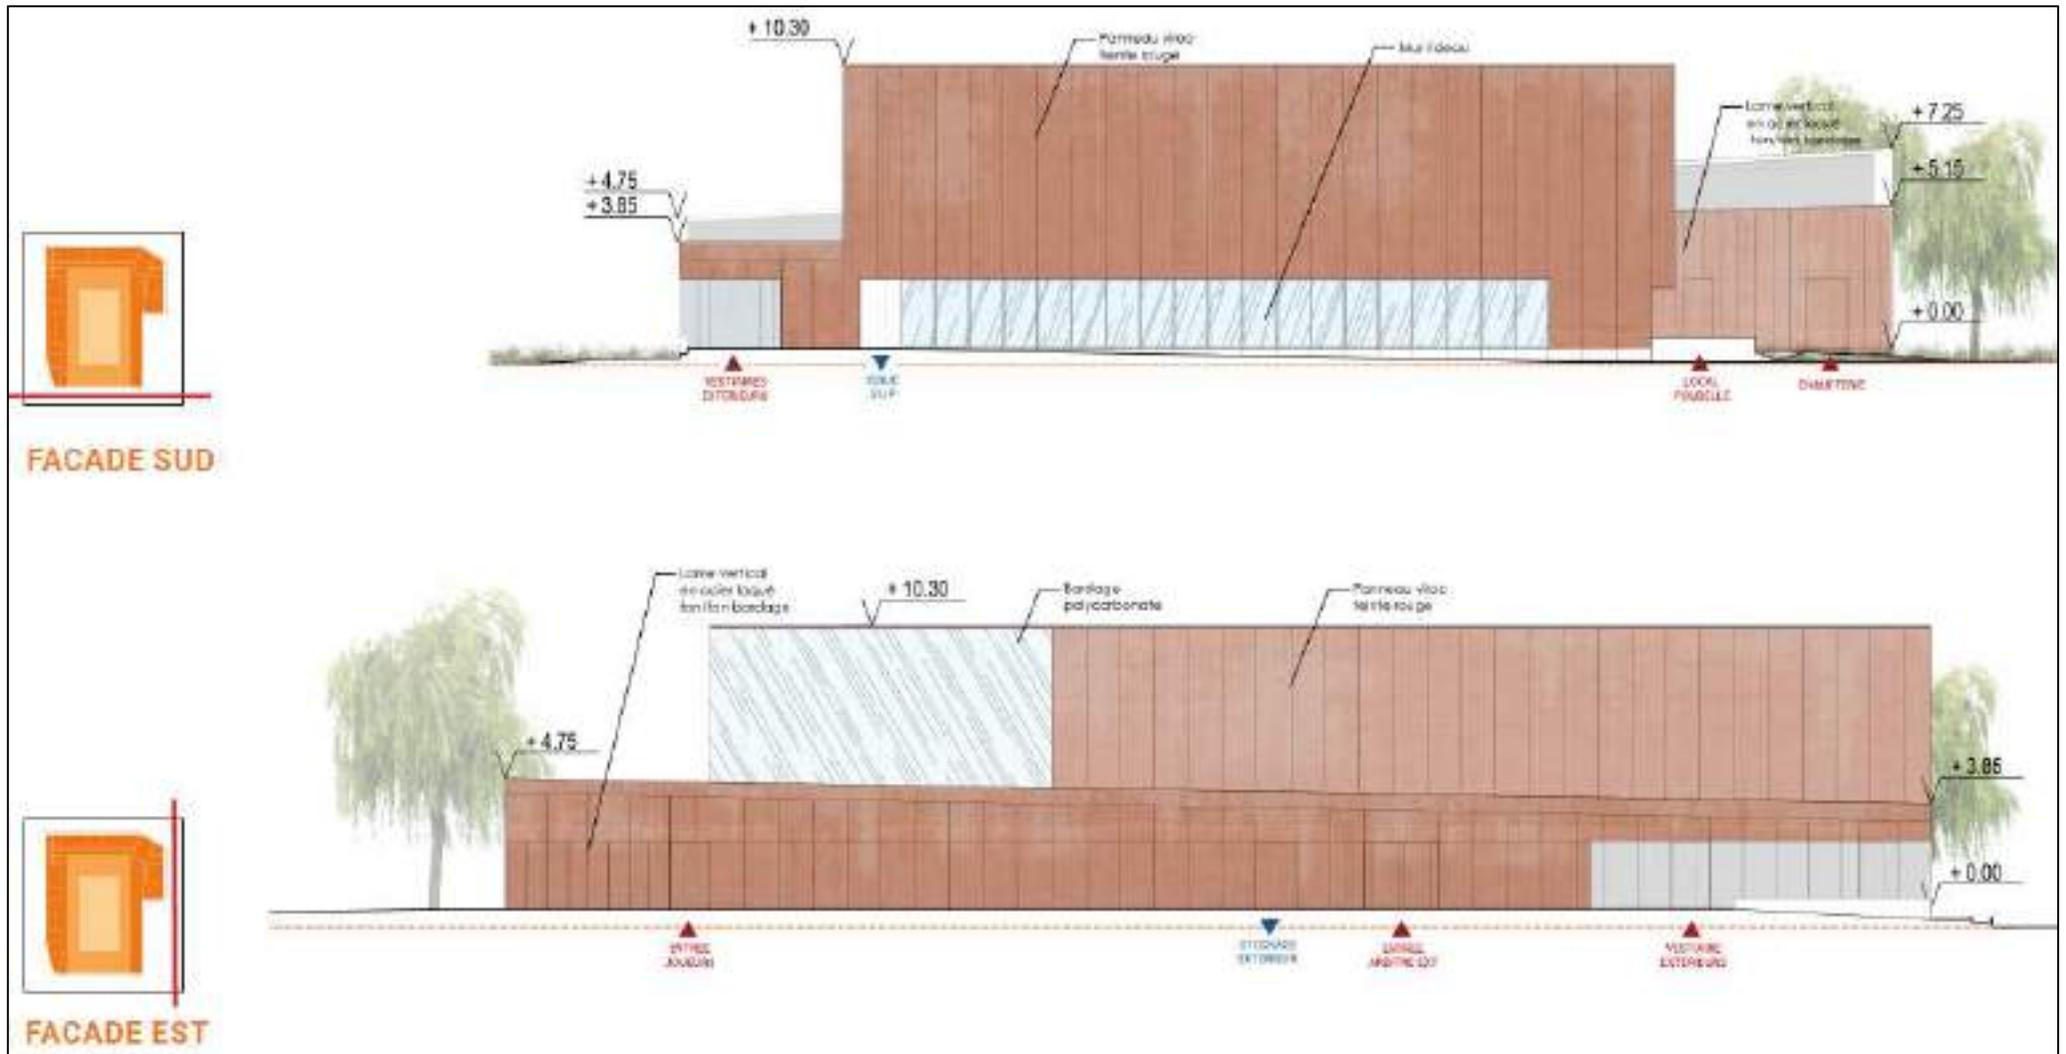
Plans des façades Sud et Est à l'échelle 1/200 (source : AVANTPROPOS ARCHITECTES)
